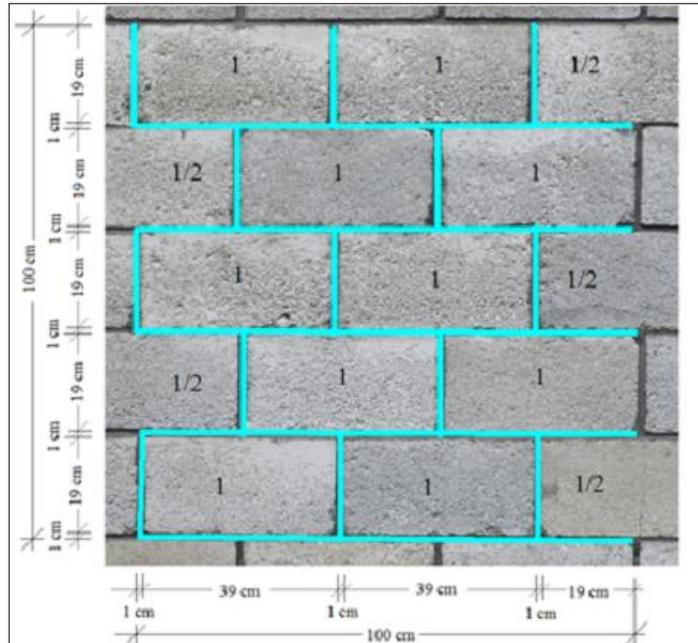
Detalles de 1 m² de pared de bloques huecos de concreto
